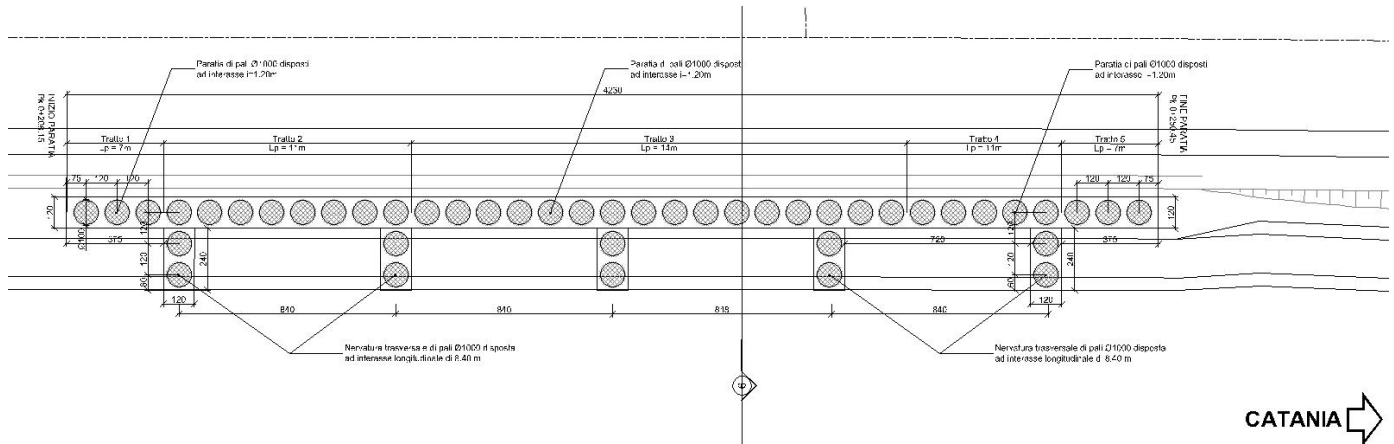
SEZIONE TRASVERSALE DELLA PARATIA
